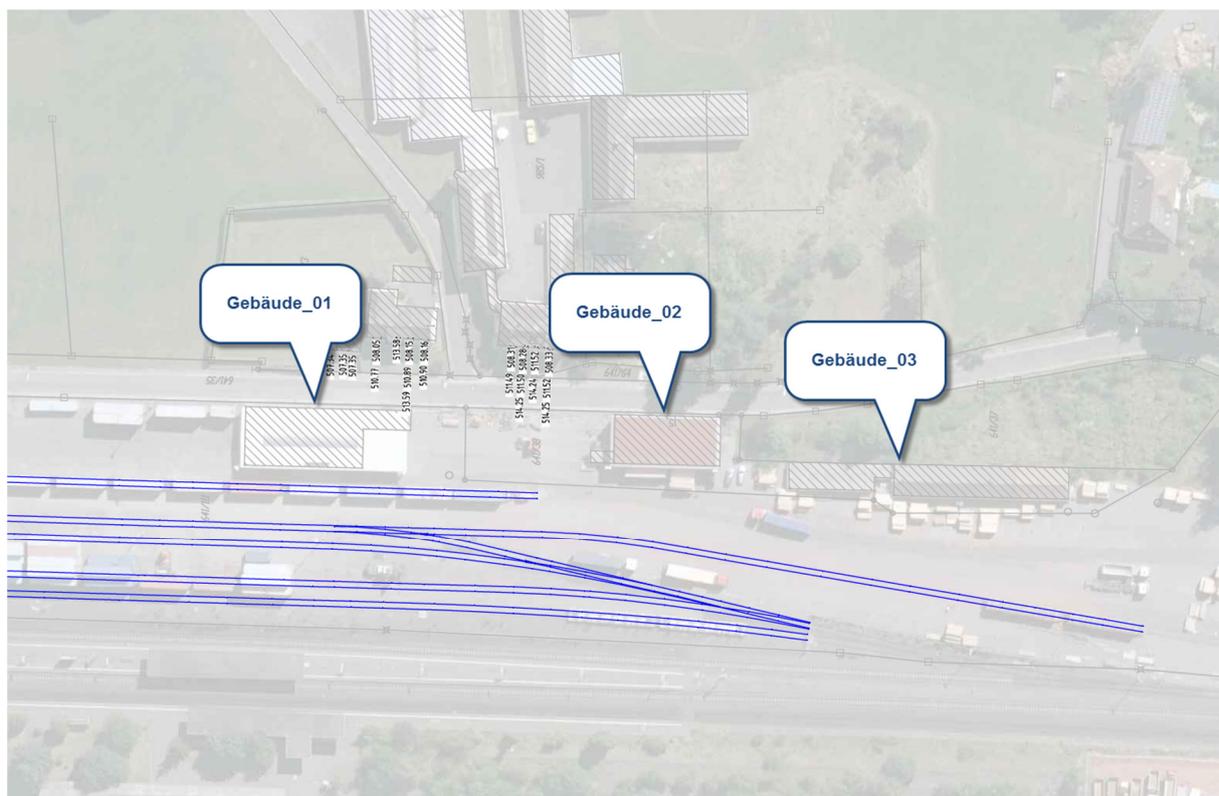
Auszug aus dem Bestandslageplan - Gebäude auf dem Betriebsgelände.
